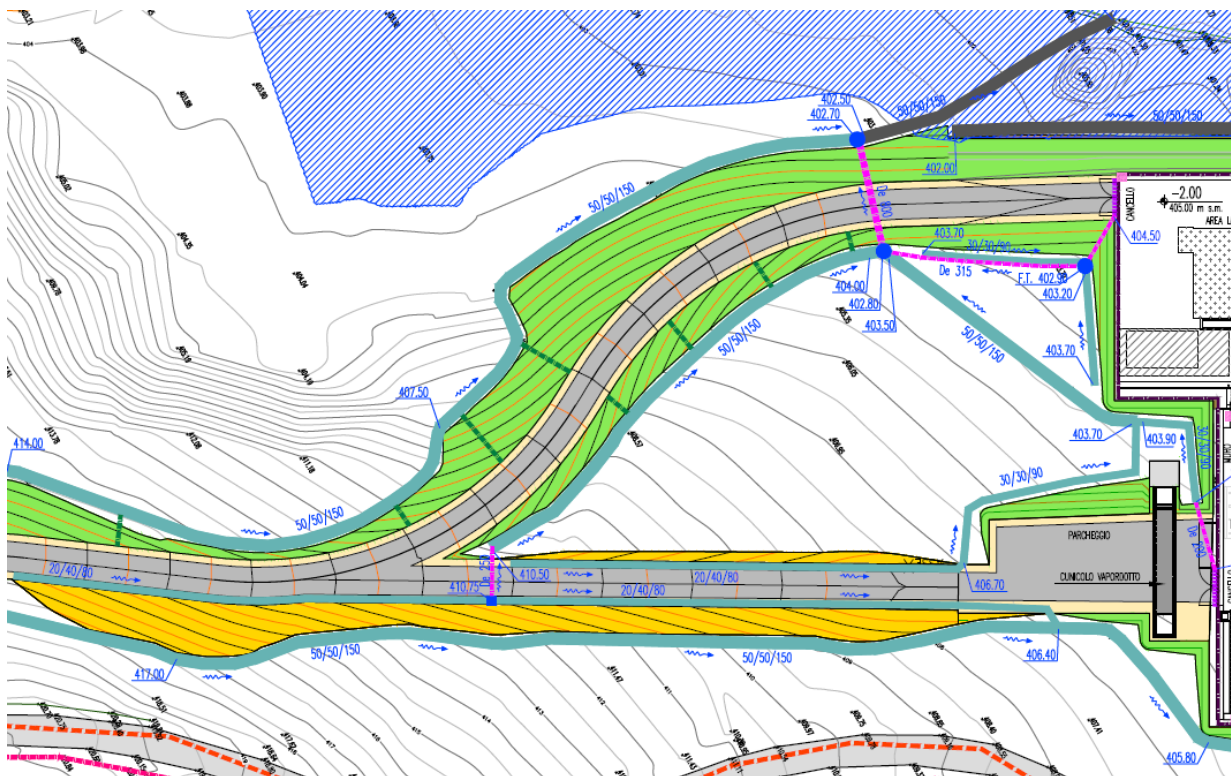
Planimetria di progetto della rete idraulica di intercettazione ed allontanamento delle acque esterne alla postazione (stralcio fossi in terra alla base dei rilevati di accesso).
